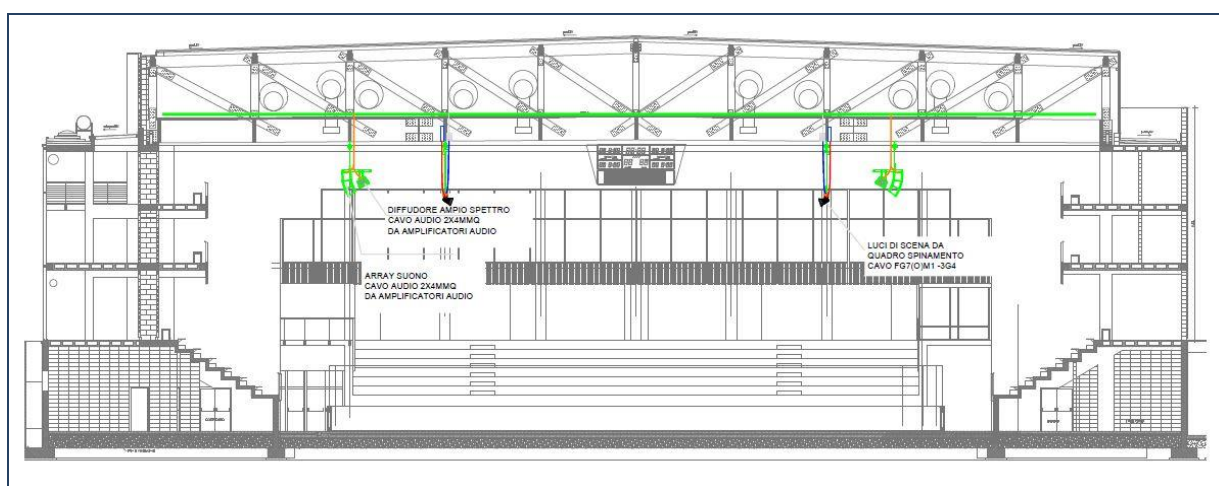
Sezione parallela alla trave reticolare maggiormente sollecitata.
